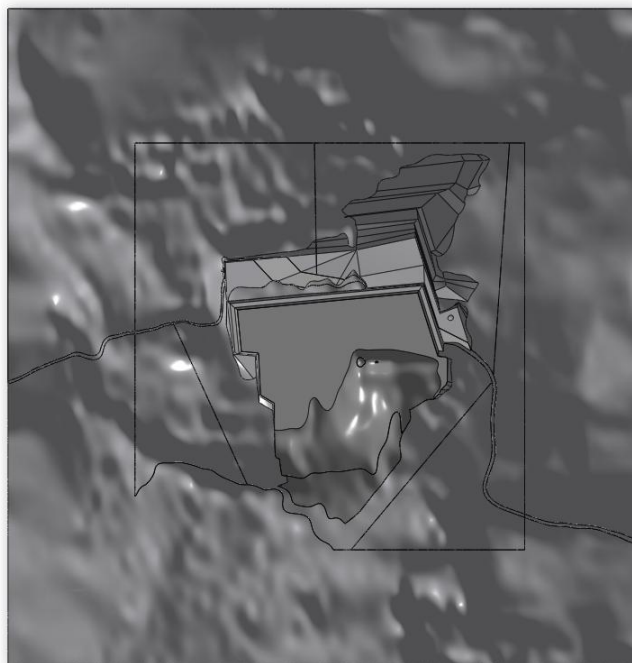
Modello geometrico 3D stato di fatto – vista planimetrica
